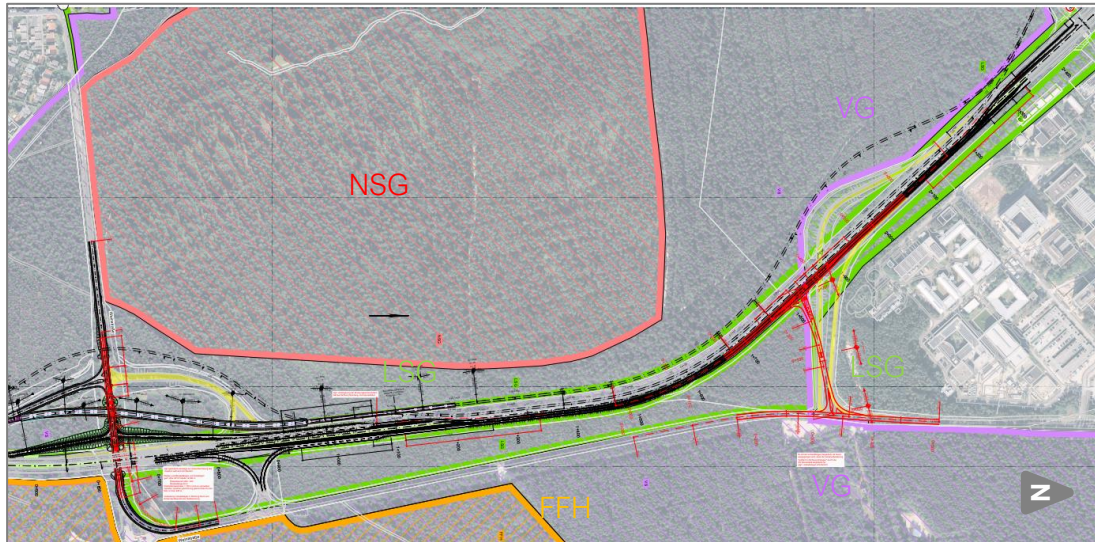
Aktueller Planungsstand Trassierung StUB im Abschnitt Weinstraße - Preußensteg
